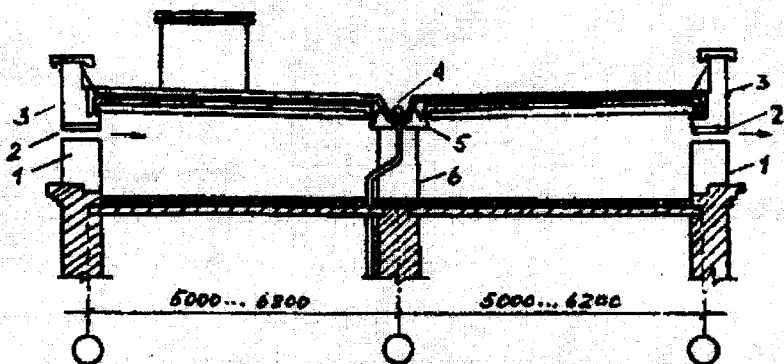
Реконструкція з'єднаного неventильованого покриття житлового будинку в залізобетонне горищце: 1 – частина, що надбудовується; 2 – вентиляційний отвір; 3 – парпетний блок; 4 – водоприймальна лійка; 5 – прогін; 6 – цегельний стовп
